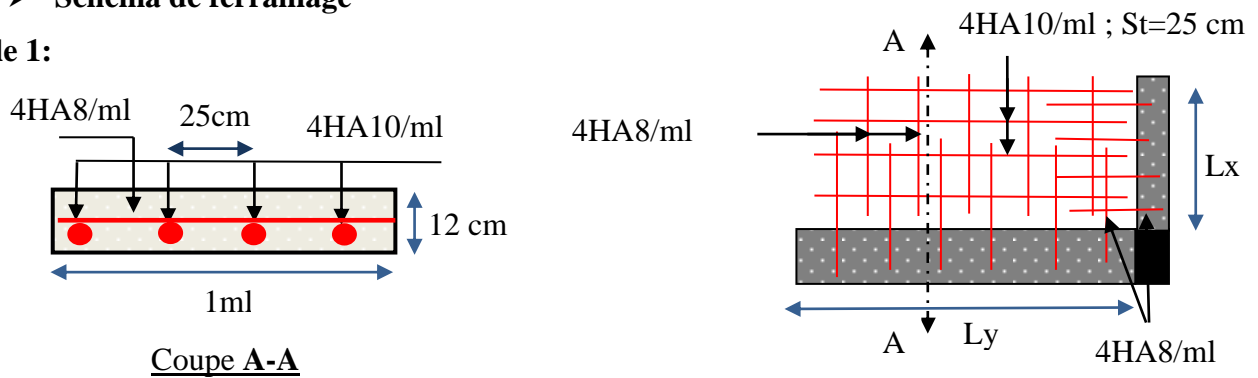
ferrailage de panneau dalle sur 2 appuis (balcon)
